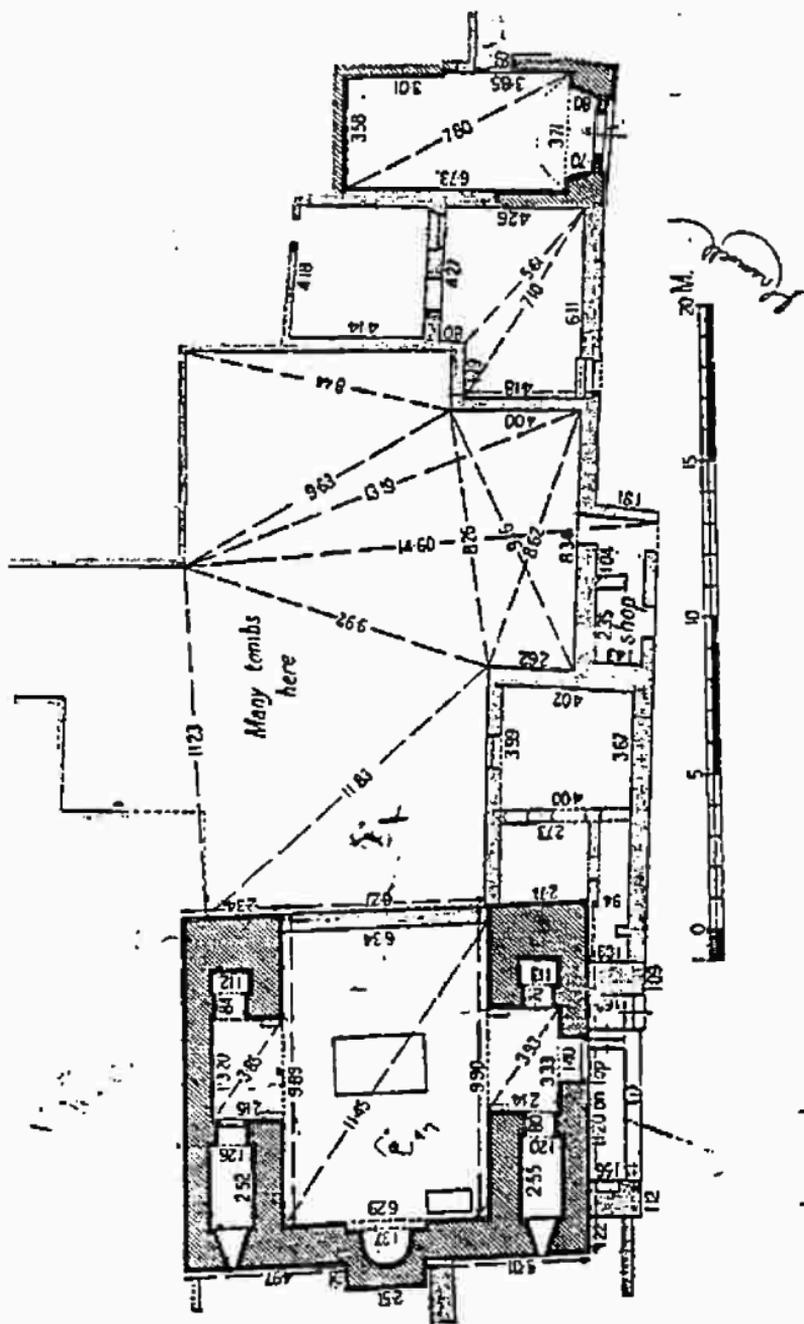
مسقط أفقي مقترح لجامع القرافة الكبرى. (عن: Bloom)
